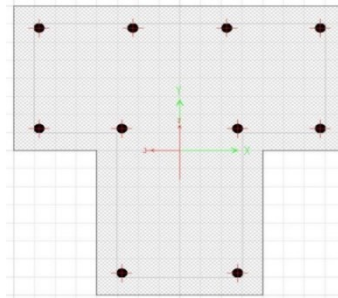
Diseño final de viga VP-102 (25xVAR)
